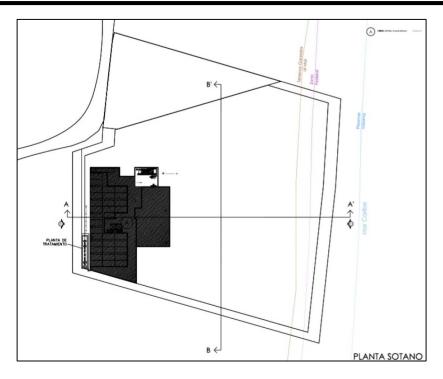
Plano arquitectónico de la planta sótano del proyecto.
